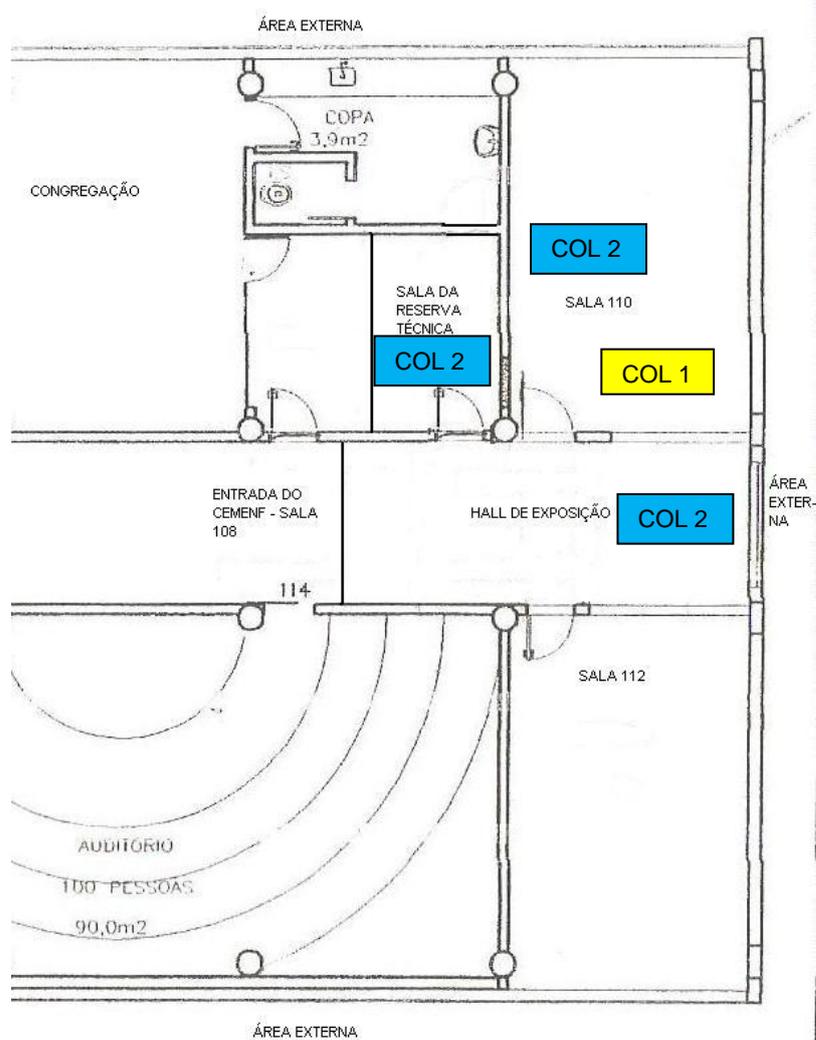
Detalhe da planta salas 108, 110, 112 e Reserva Técnica (1º ANDAR)
